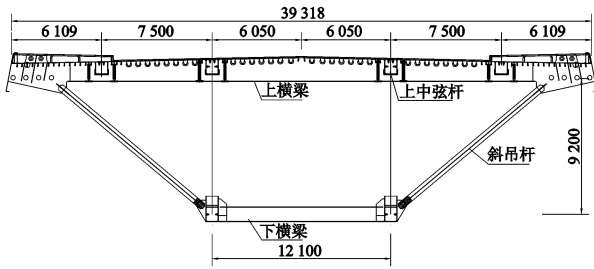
菜园坝大桥主梁断面示意图 (单位: mm)
